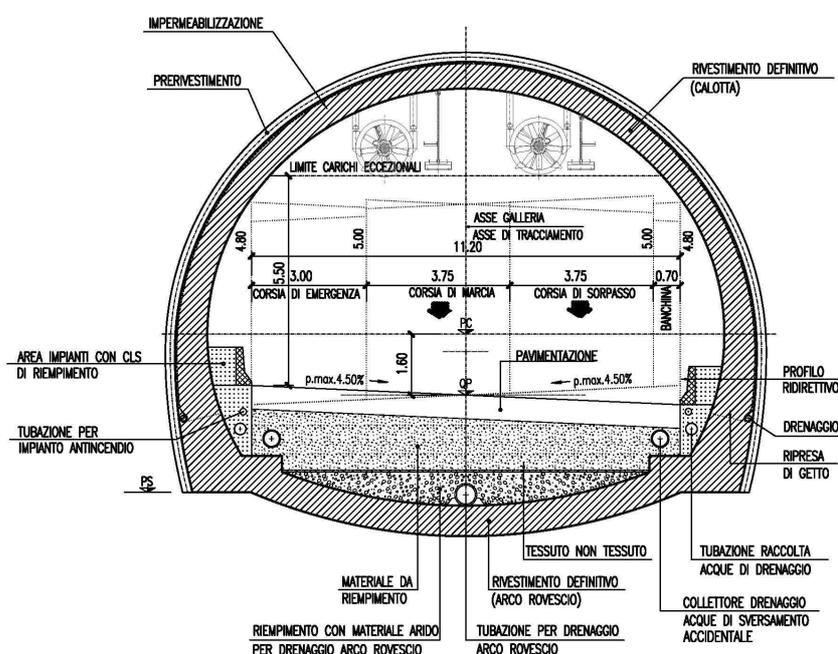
Sezione tipo in galleria naturale con scavo tradizionale
